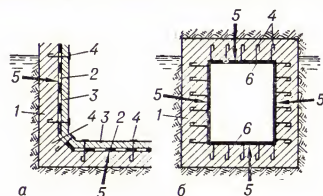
Поверхностная гидроизоляция, работающая «на отрыв»: а — асфальтовая гидроизоляция; б — металлическая гидроизоляция; 1 — несущая конструкция; 2 — поверхностная гидроизоляция; 3 — защитное ограждение; 4 — стальные анкеры; 5 — напорный фронт воды; 6 — стальная обшивка.
